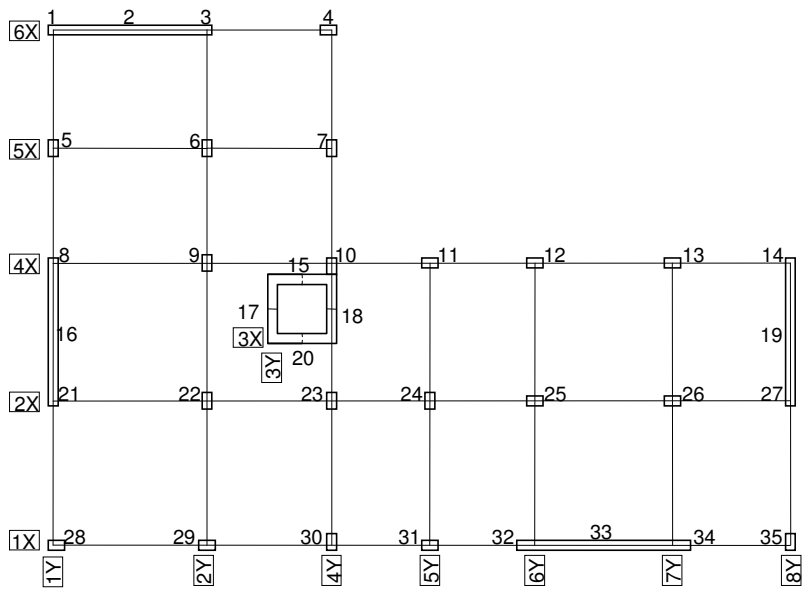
Schema geometrico della struttura con parete 33 allungata
